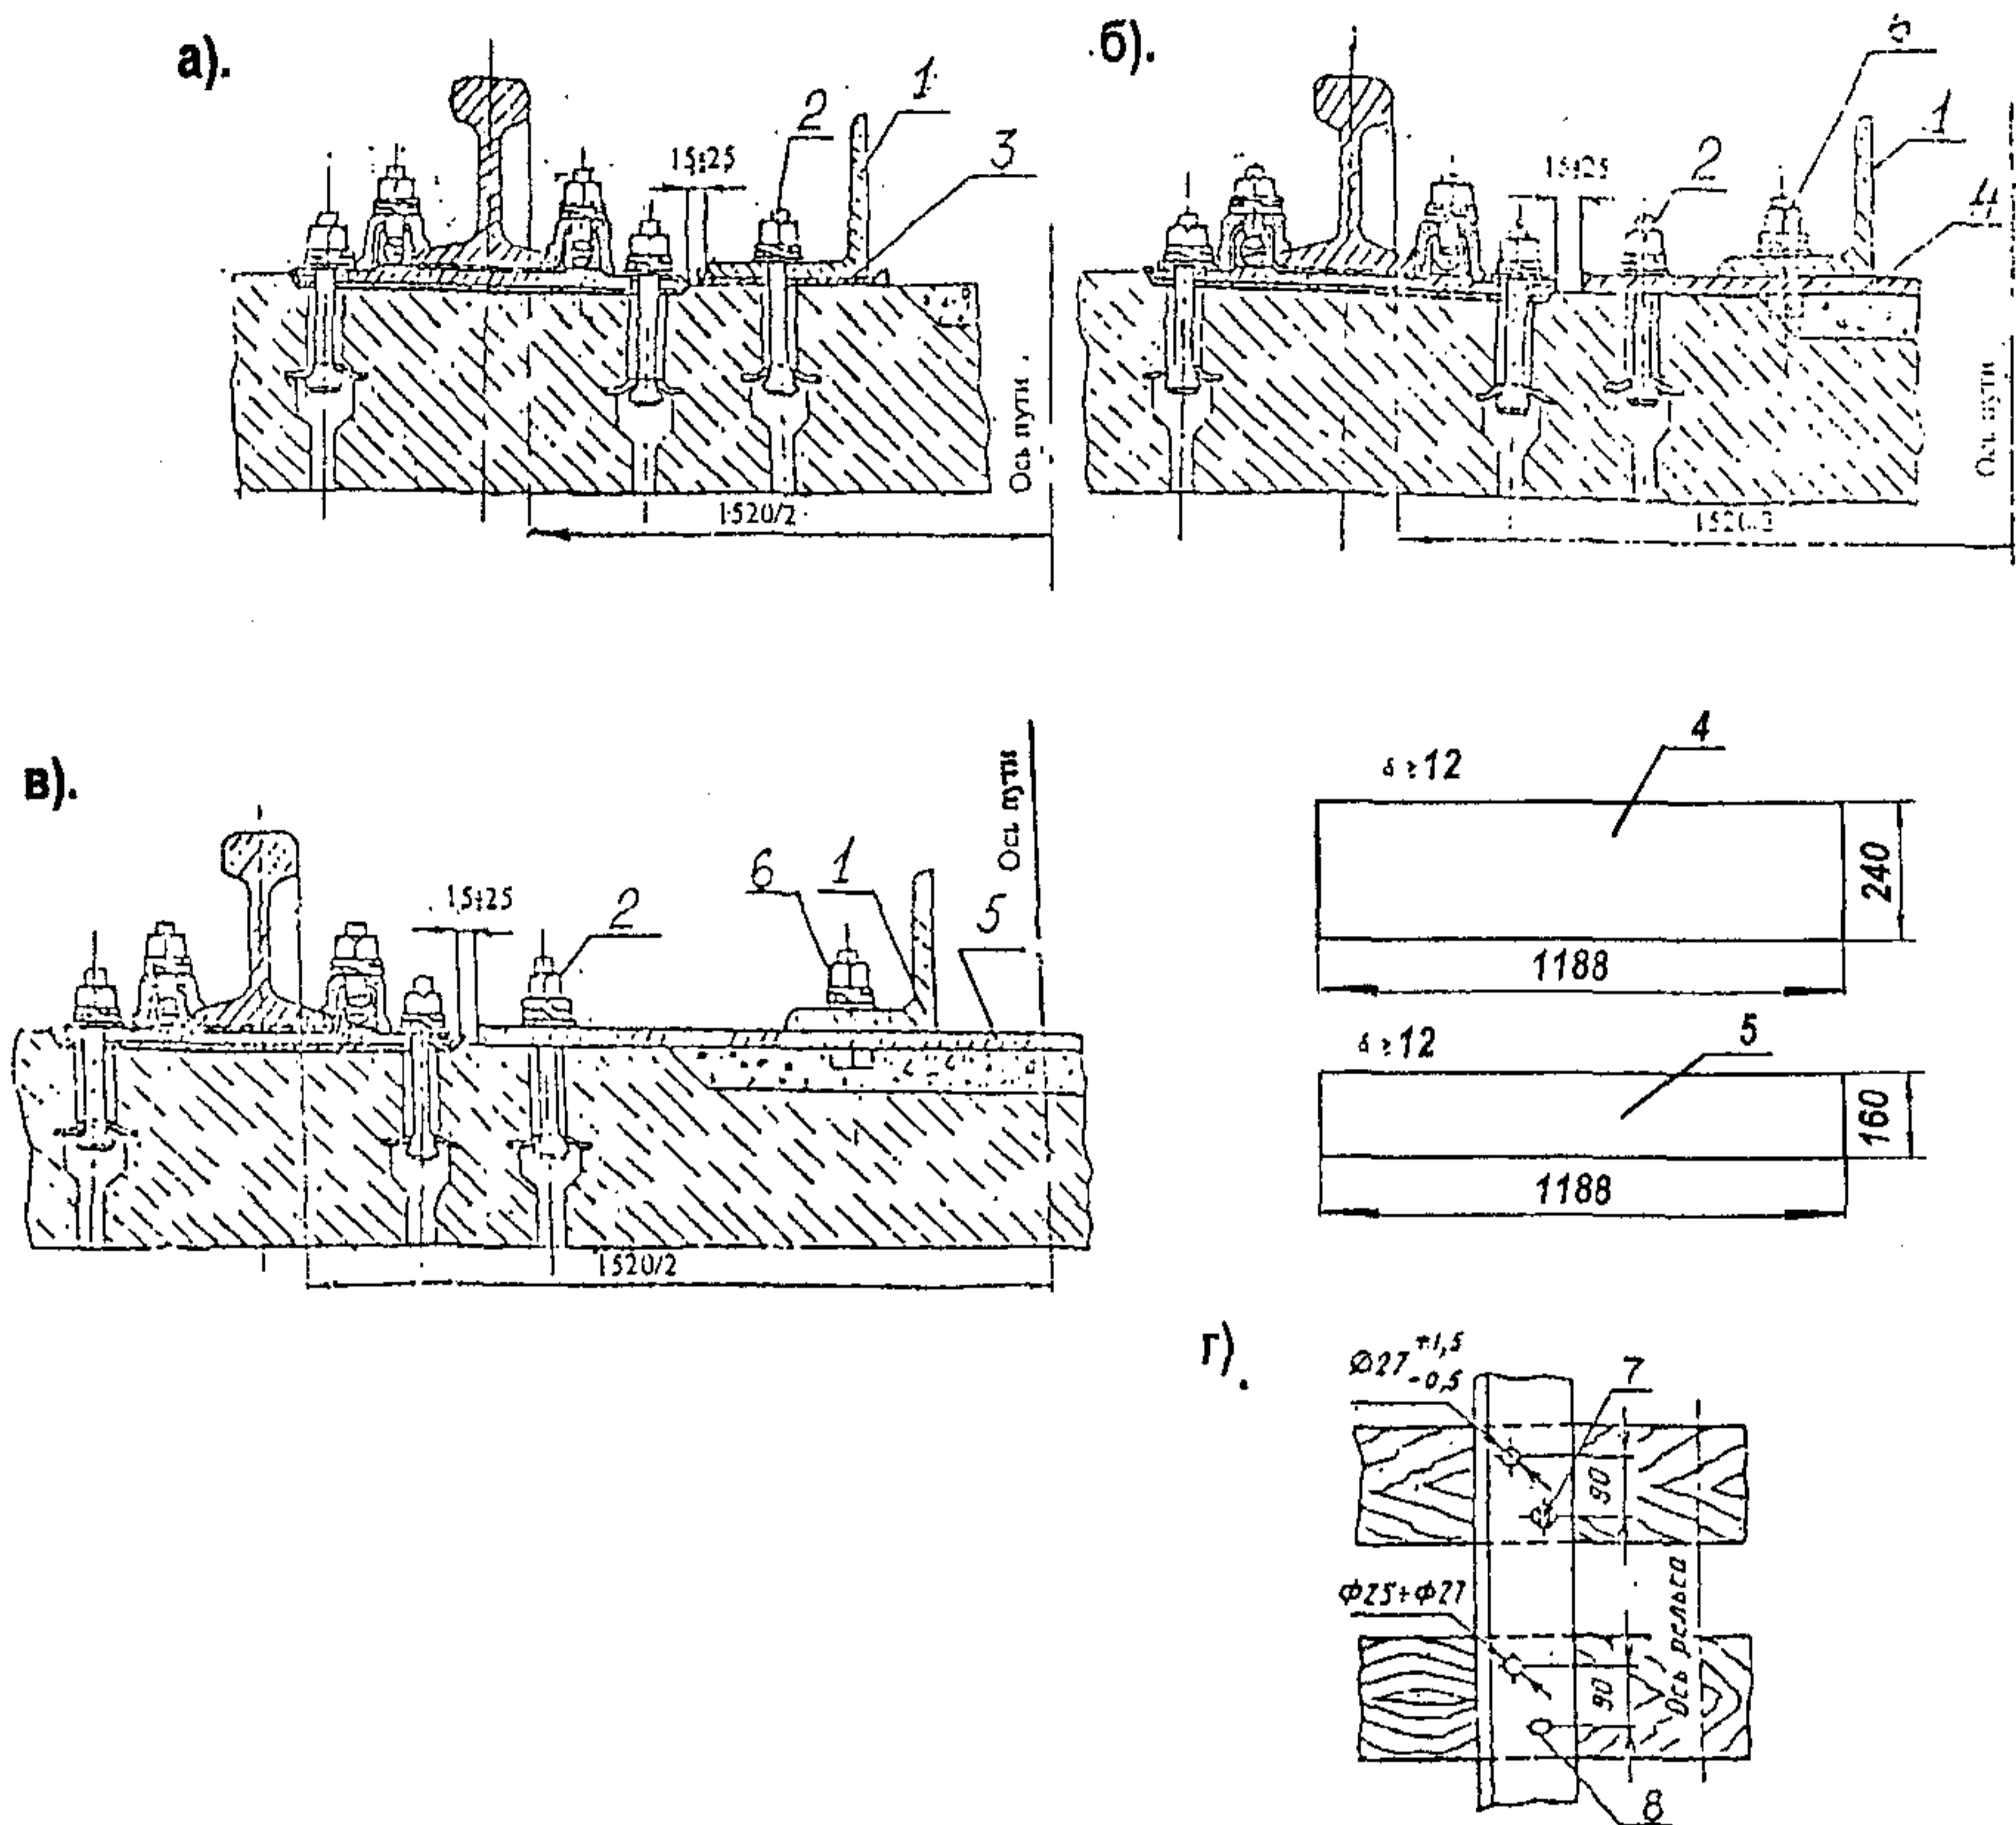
Крепление контруголков к железобетонным шпалам и деревянным шпалам и брусьям
